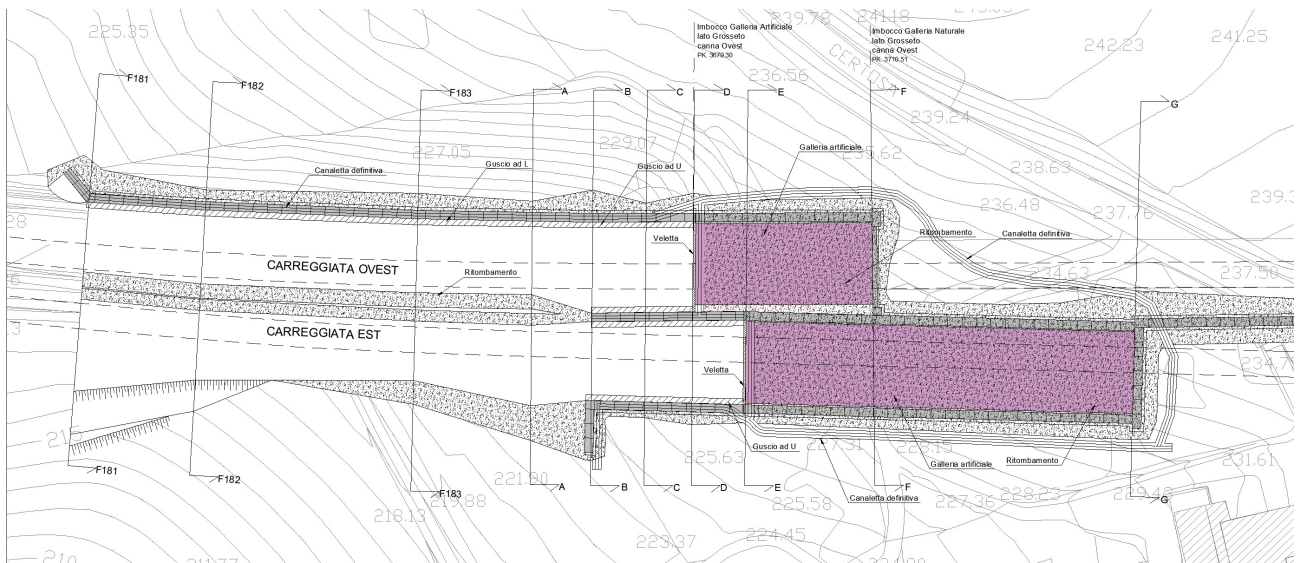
Planimetria galleria artificiale Bucciano - Imbocco Lato Grosseto
